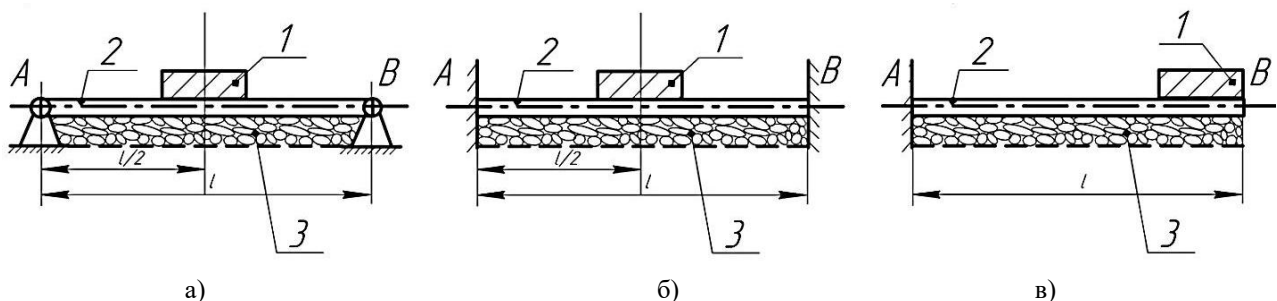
Расчетная схема к определению устойчивости пород кровли – балки на упругом основании: а) с неподвижными шарнирными опорами; б) с двусторонней жесткой заделкой; в) консольная балка:
